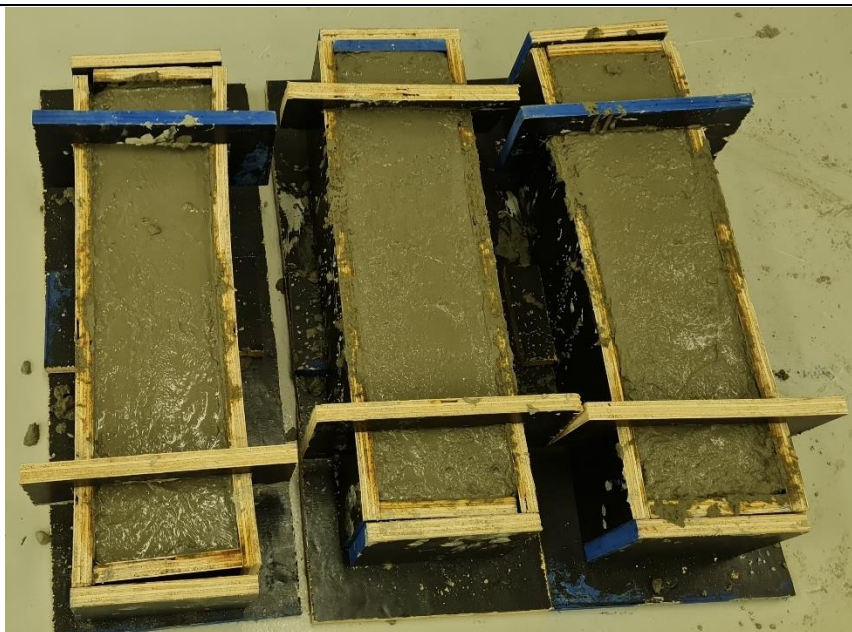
Fôrmas de madeira concretadas. Fonte: Autor
